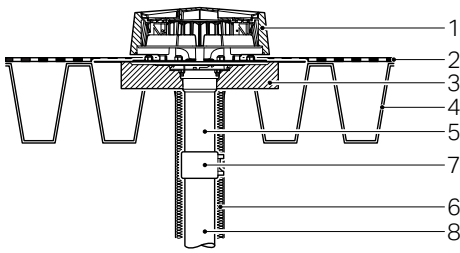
Aufbau Leichtdach mit Dachabdichtungsfolie
